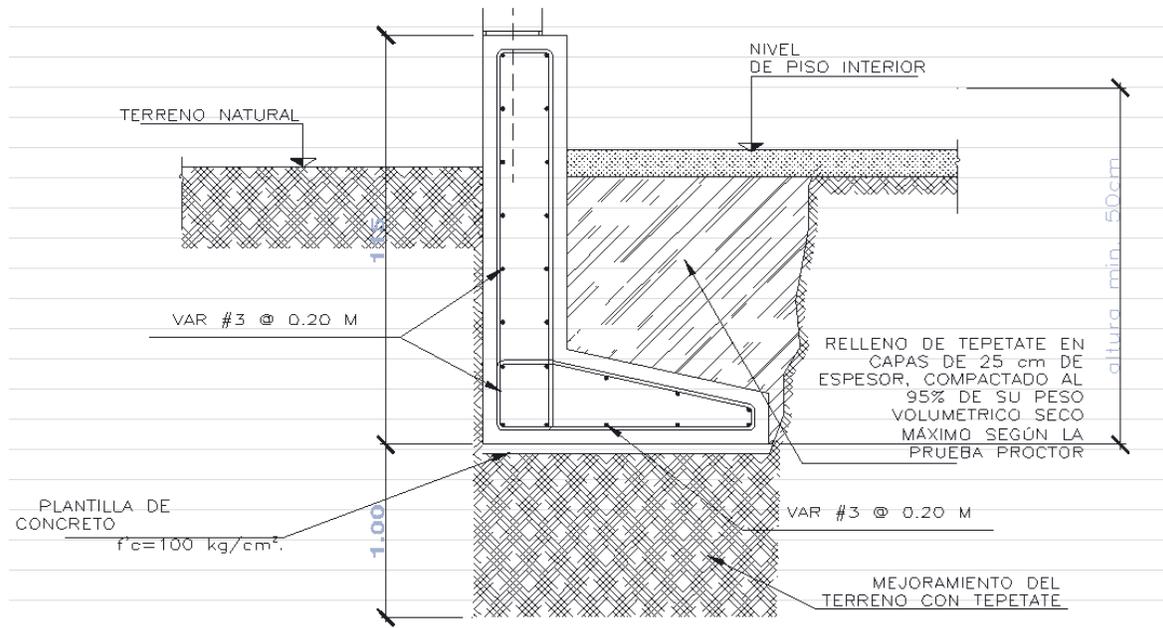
Diseño de cimentación utilizado en tramos 1 y 3 de barda perimetral (Fig. 1), con zapatas con doble parrilla y contratrabes de cimentación, con acero de refuerzo de 3/8 de pulgada y mejoramiento de terreno de 1 metro en capas de 20 cm.
